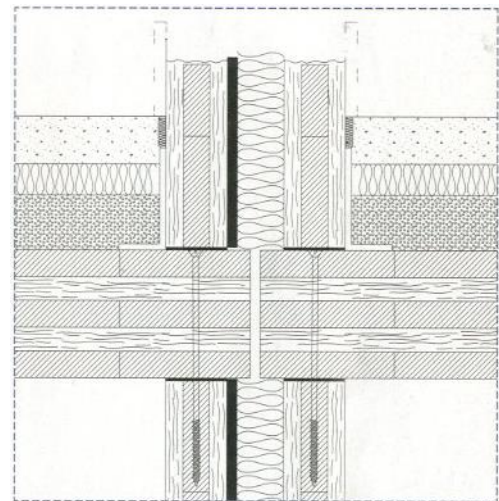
Coupe de détail sur les planchers et murs séparatifs entre logements
